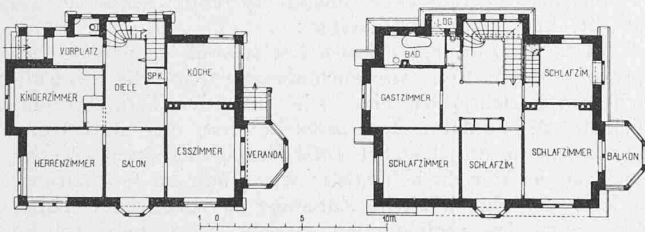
Wohnhaus Oehler — Grundrisse 1:400.
